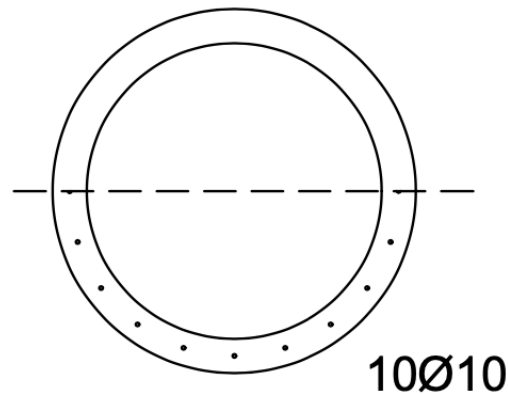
Determinación de armado en base a la armadura mínima - Fuente propia
